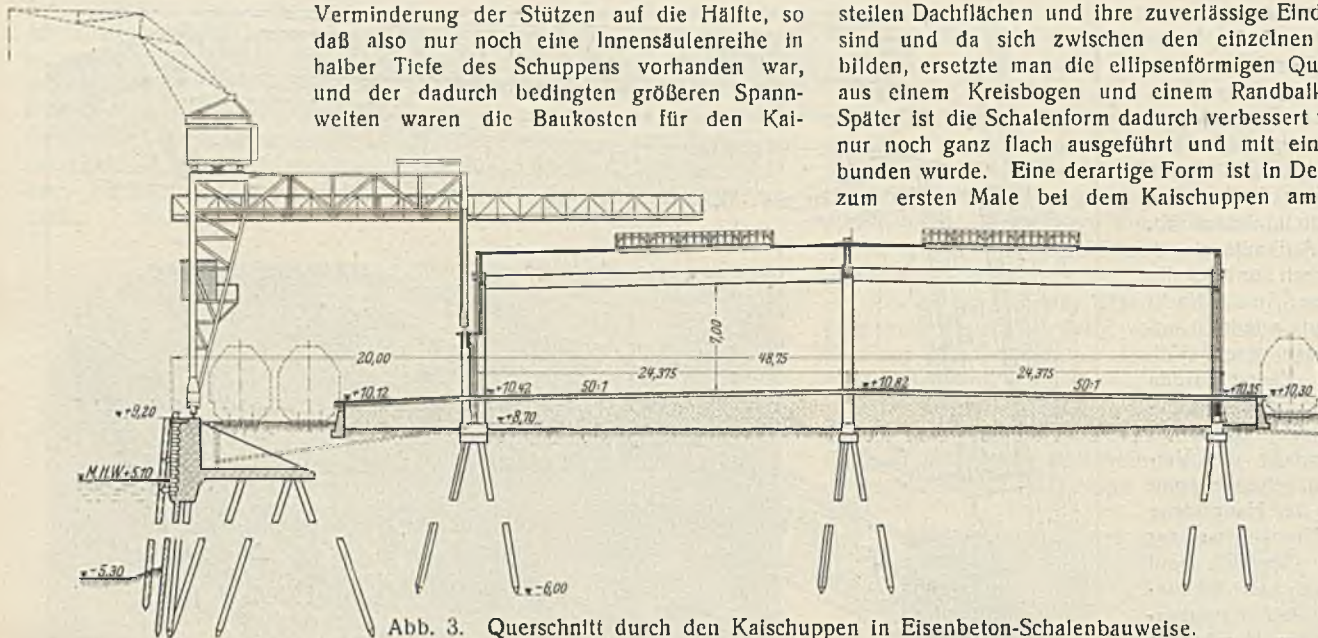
Querschnitt durch den Kaischuppen in Eisenbeton-Schalbauweise.
